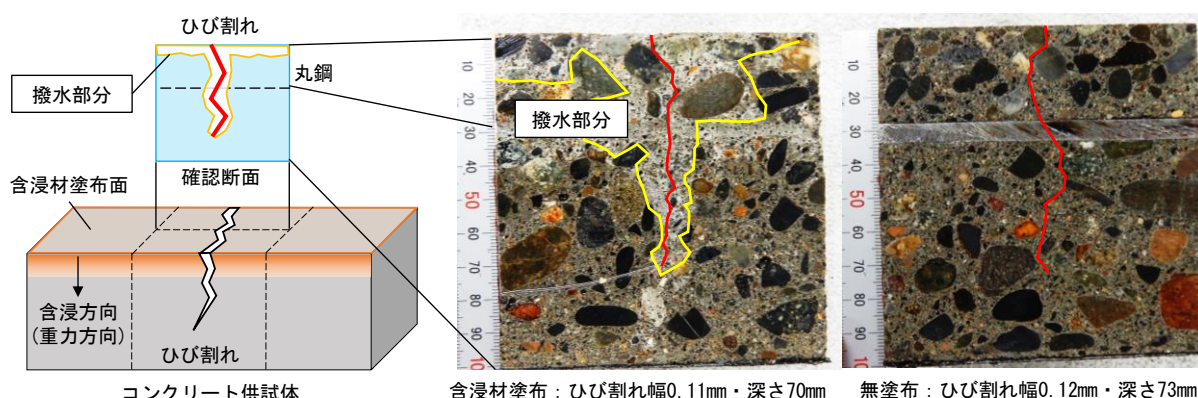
ひび割れを有するコンクリート断面の撥水状況
